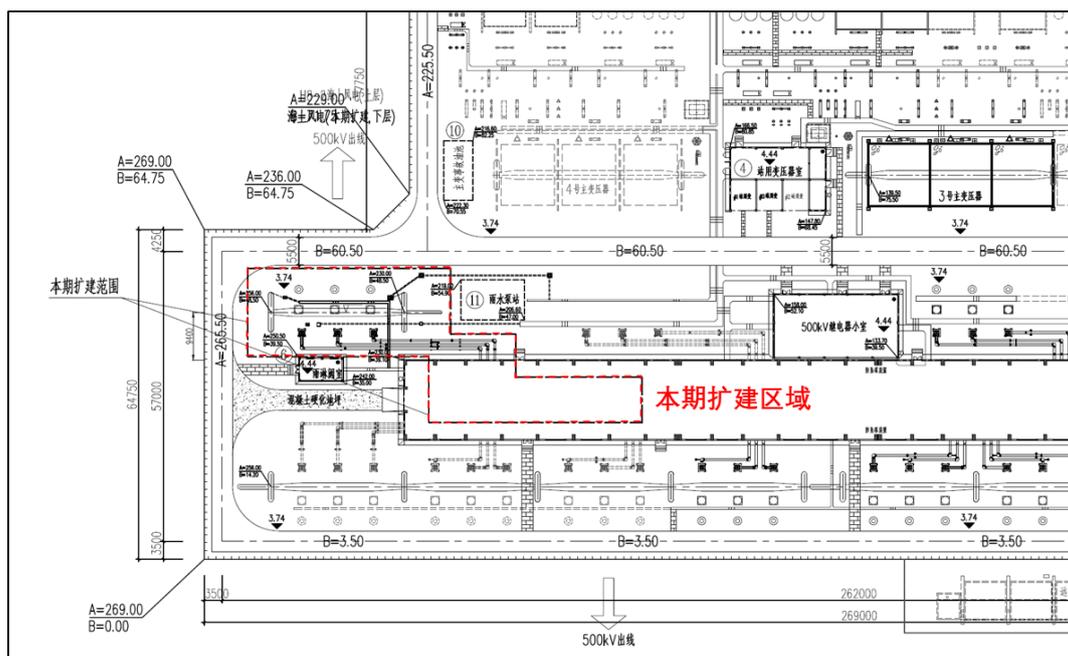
鹿乡变平面布置示意图（本期扩建部分）
